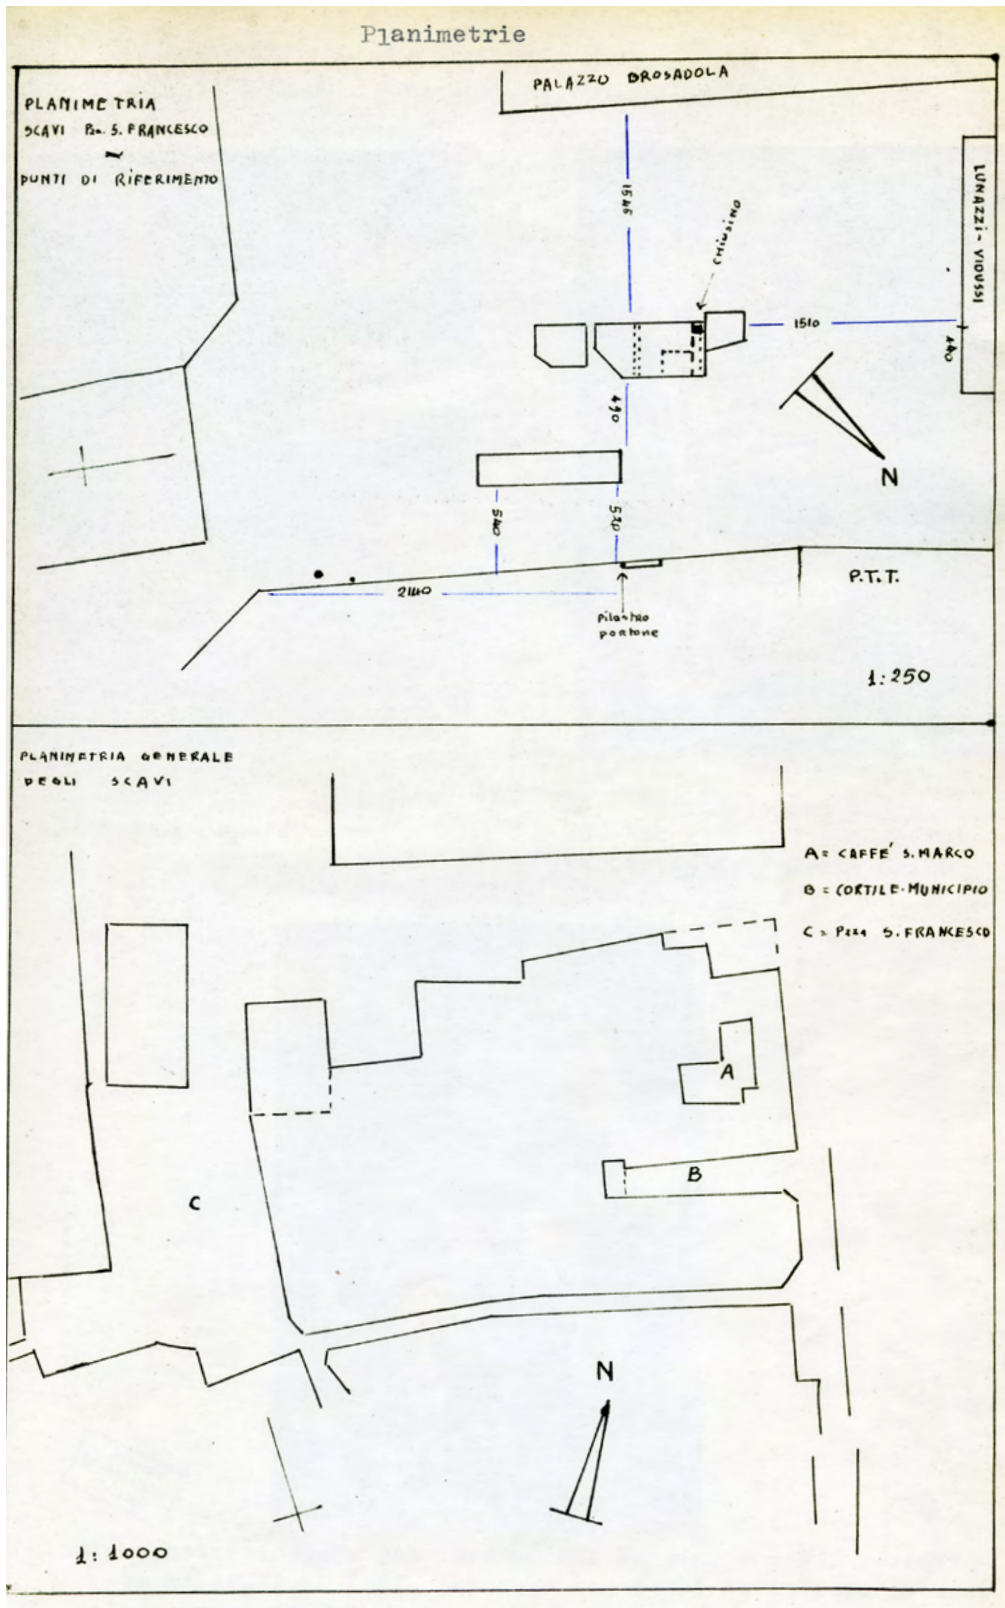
Planimetria degli scavi in Piazza san Francesco (cfr. la localizzazione in FIG. 1e).
